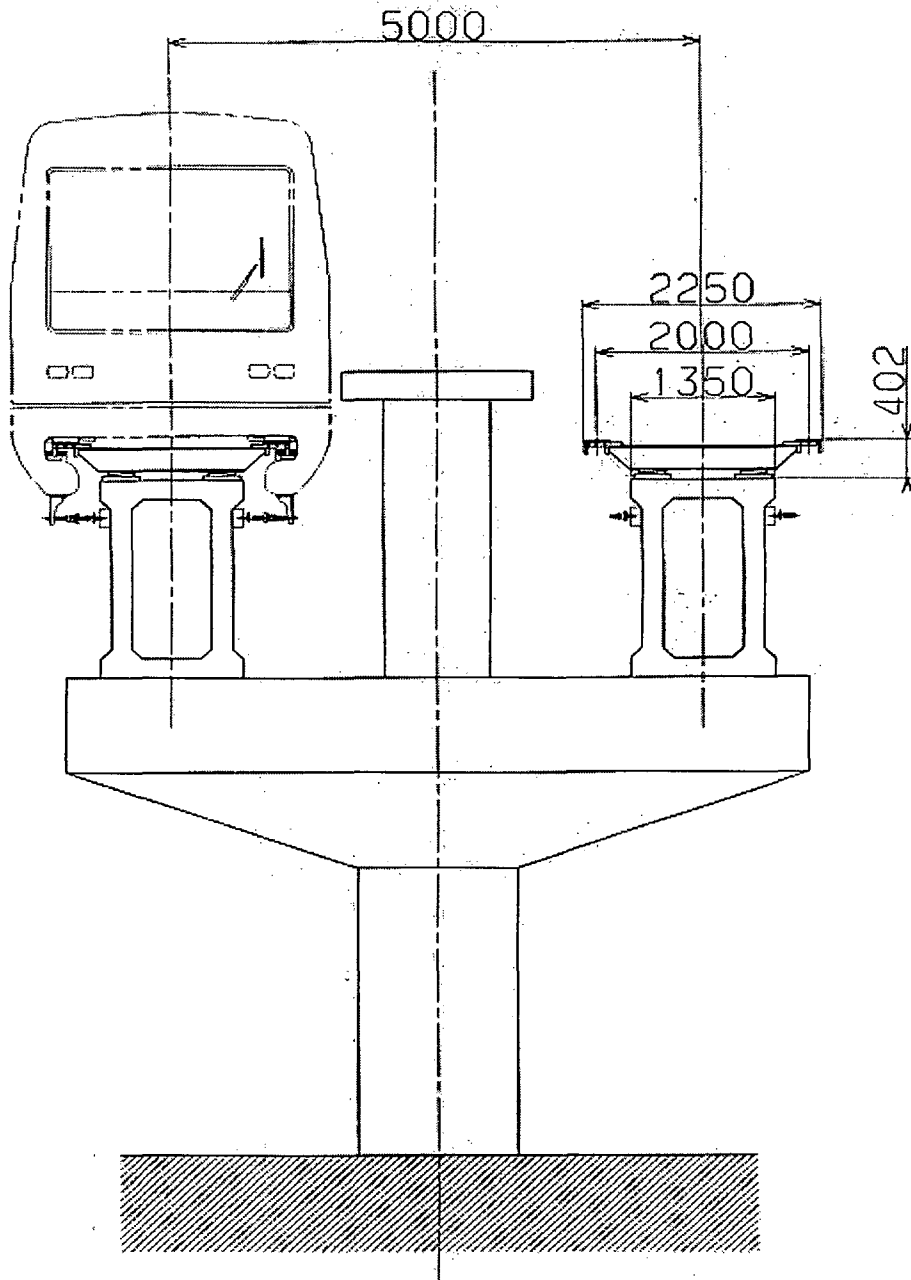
퀘도 단면도 (여객터미널 ↔ 역사2)
